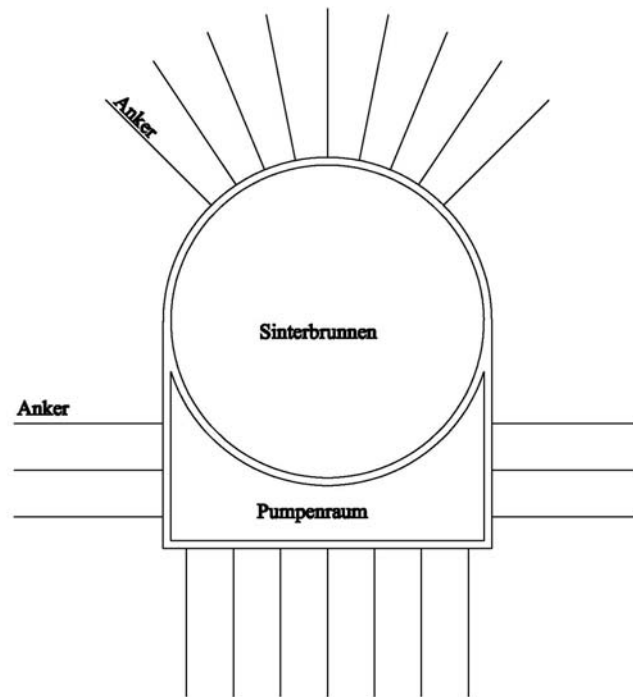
Grundriss Baugrube Sinterbrunnen und Pumpenraum
